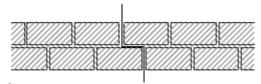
Junta de movimiento con solape. Esquema en planta
